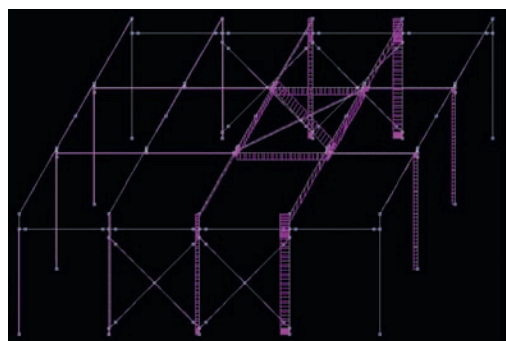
Эпюры усилий в SCAD схемы металлоконструкций
